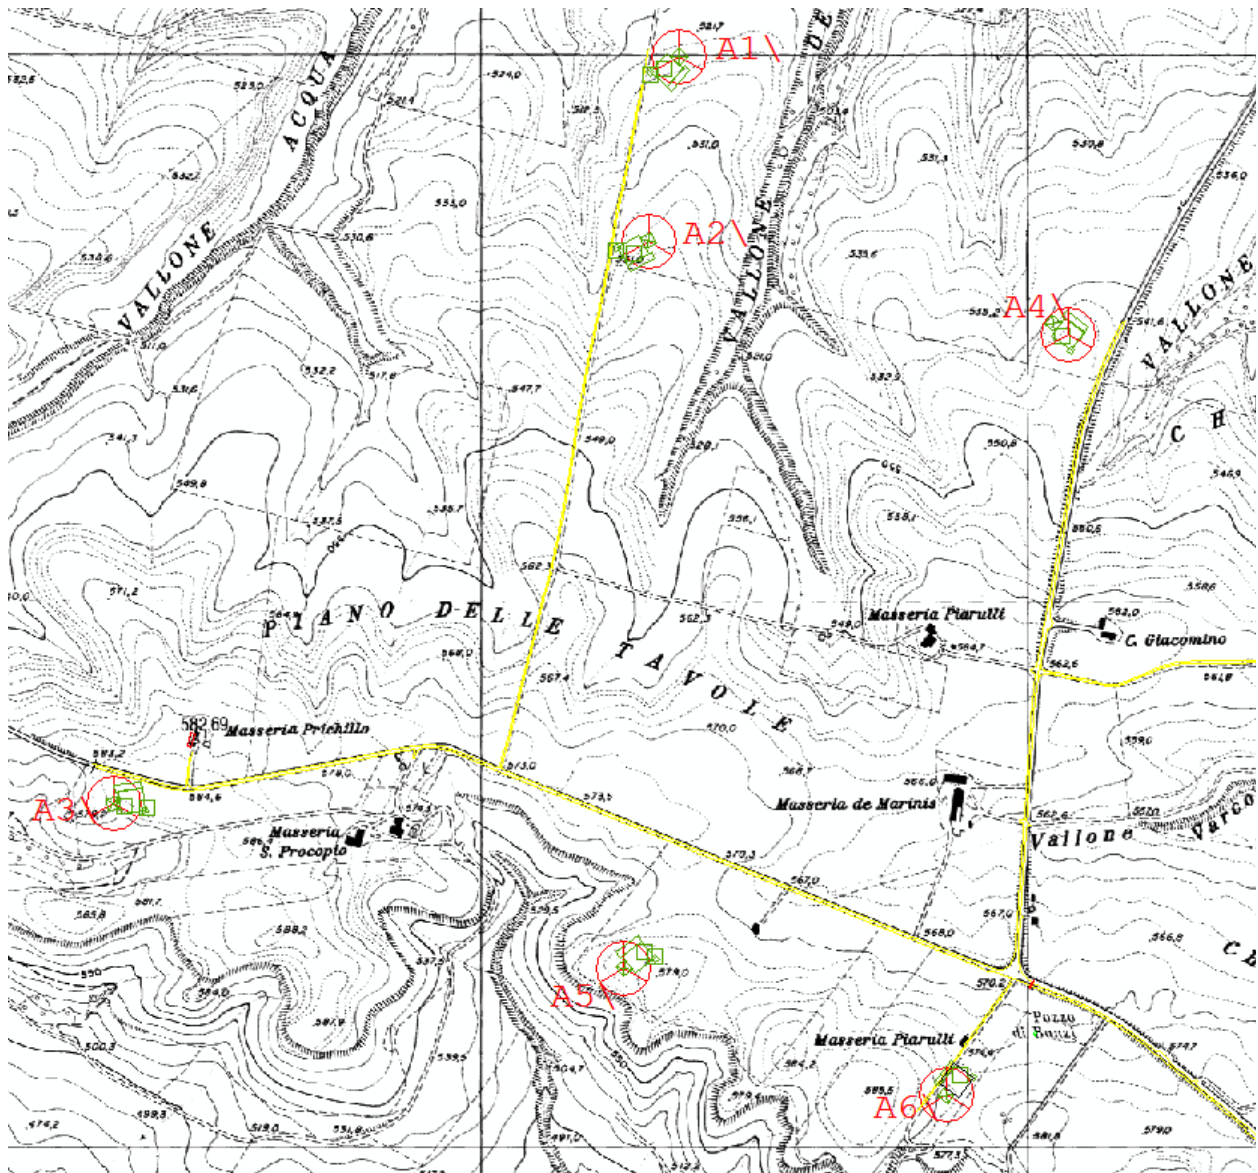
Strade e piazzole interessate dalla costruzione del parco su CTR.
